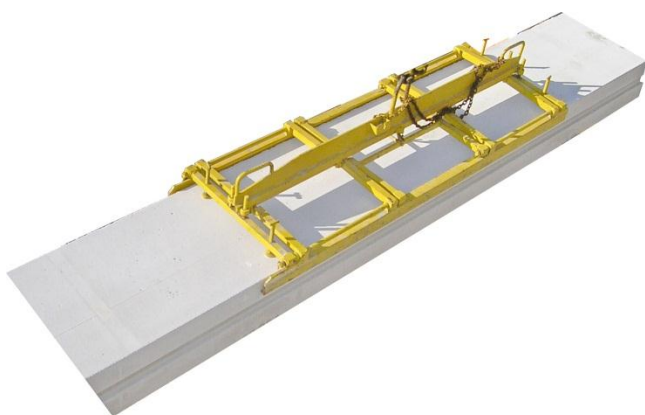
Монтаж панелей перекрытий с использованием захвата для плит
